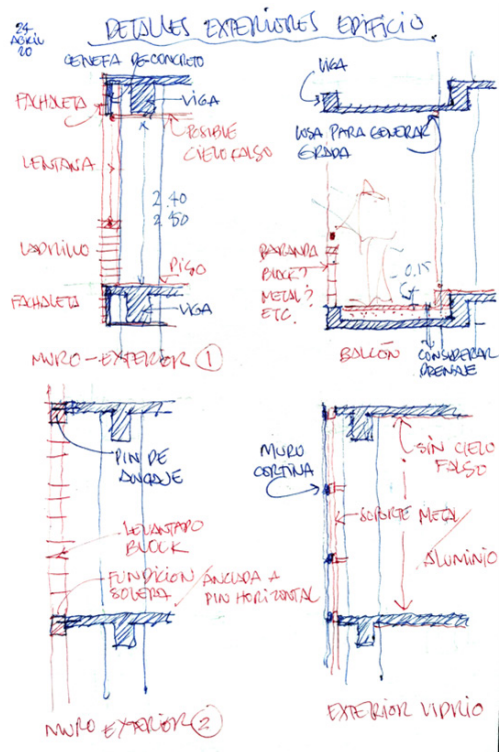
Bocetos de estructura secundaria, cerramientos con ladrillo, block y vidrio.
